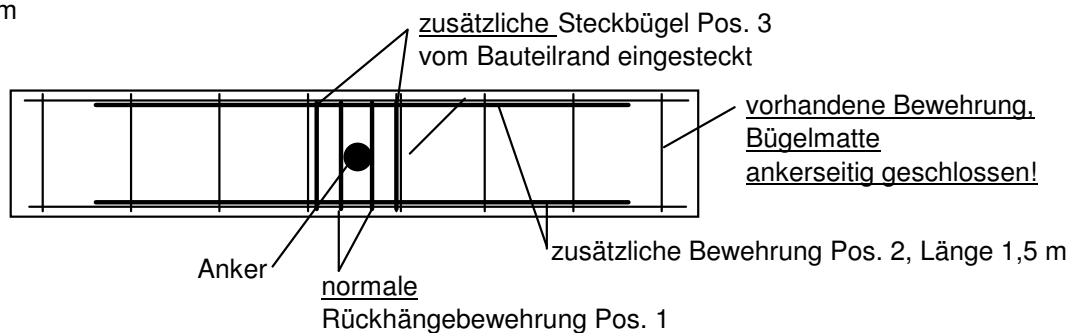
In den Versuchen unter Querkzug und Schrägzugbelastung mit Doppelwellenankern lang (DWL) vorhandene zusätzliche Bewehrung
